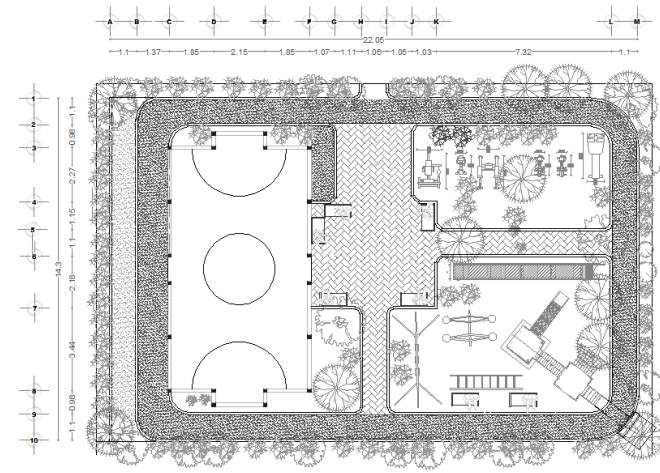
Plano de conjunto. Imagen 21. Fachadas proyecto parque.
